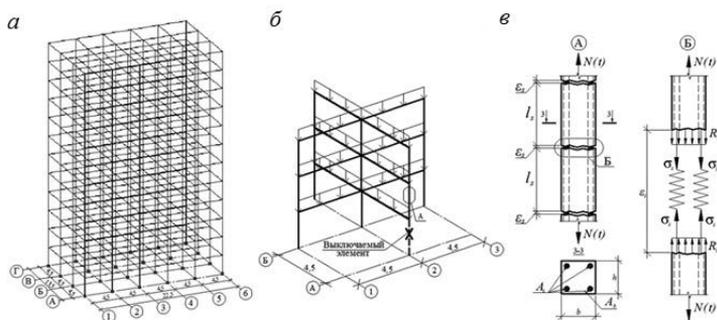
Расчетные схемы первого (а), второго (б) и третьего (в) уровней при расчете железобетонного каркаса 12-этажного здания
